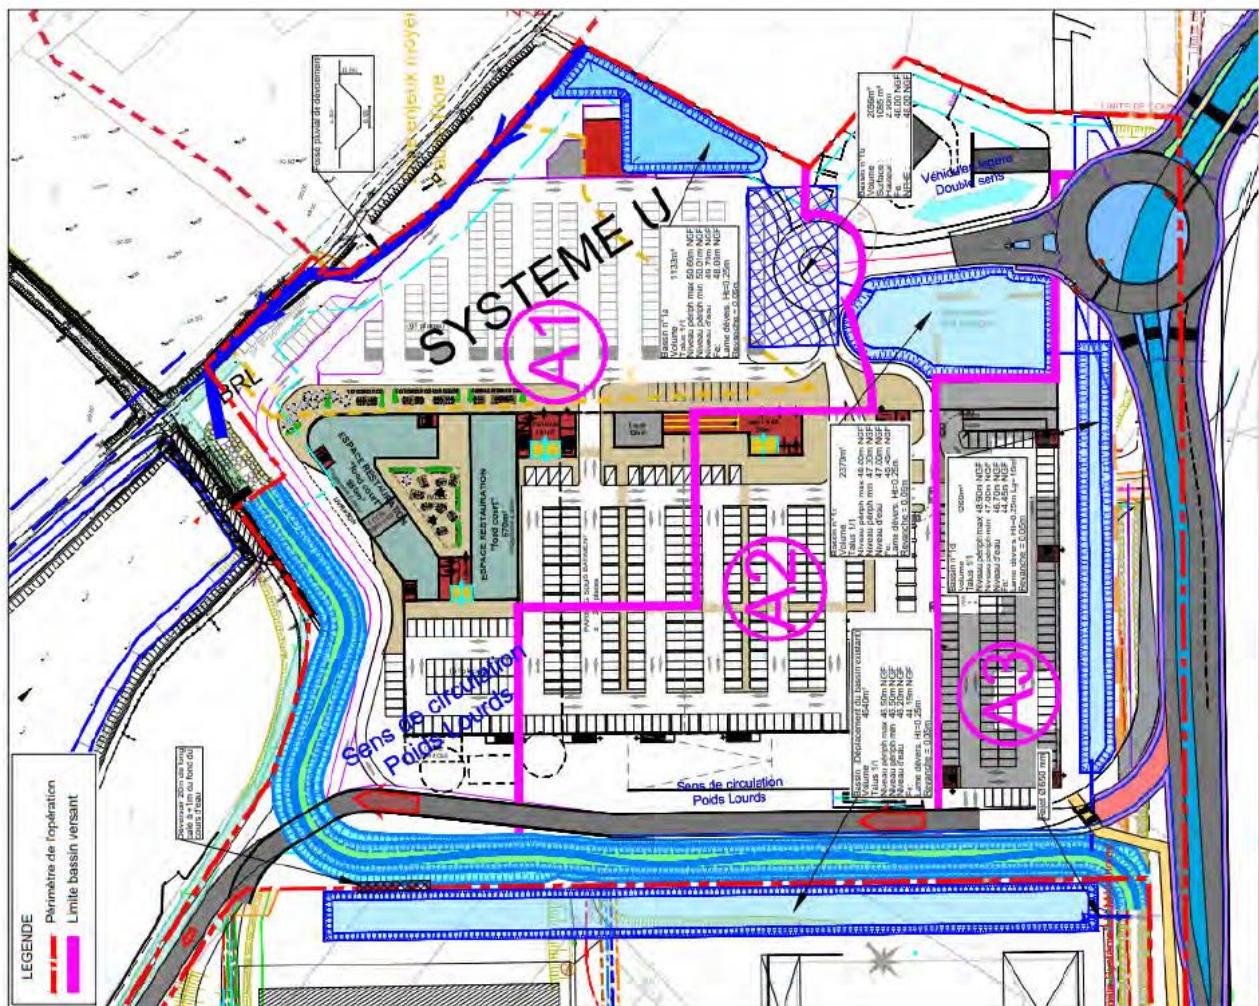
Plan de gestion hydraulique du dossier cas par cas (Source : TECTA, 2021)
